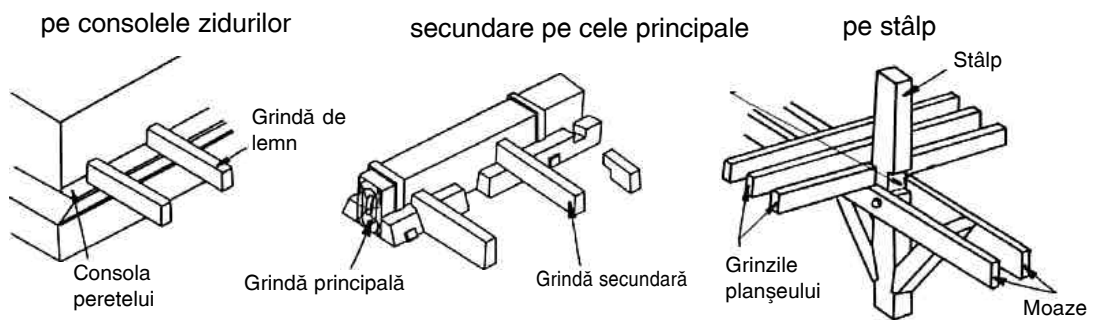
1 Planșeu cu grinzi din lemn. Alcătuire constructivă. Rezemarea și ancorarea grinzilor de lemn
